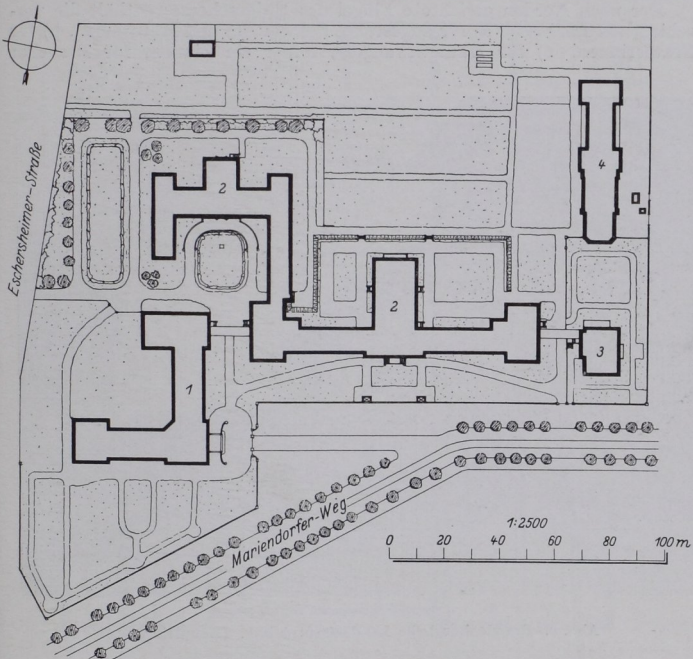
Lageplan der Brandenburgischen Landesfrauenklinik.
